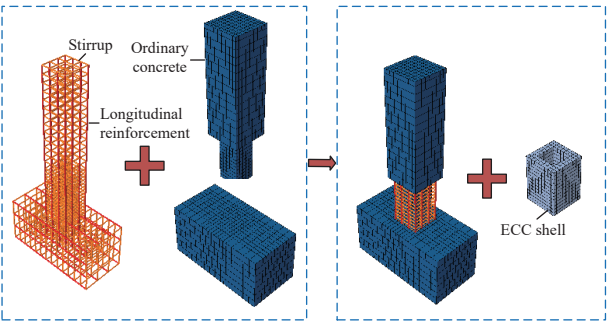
工程水泥基复合材料(ECC)壳(节段)-钢筋混凝土(RC)组合墩柱构造
